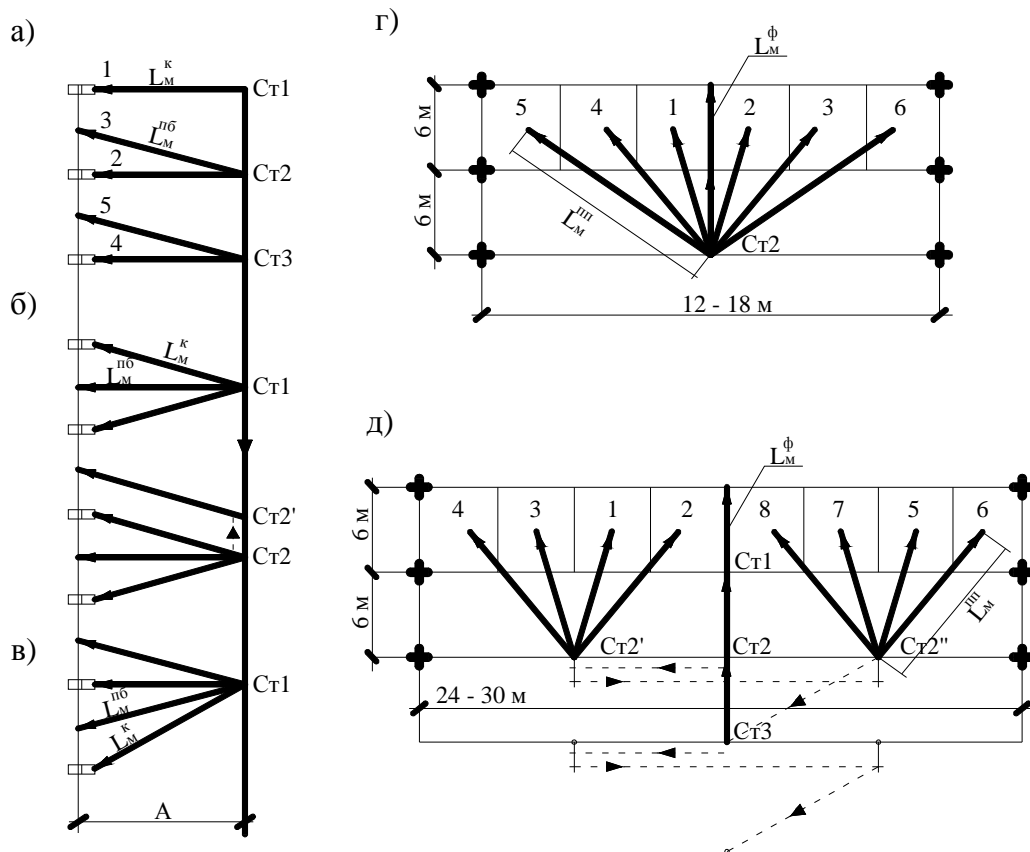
Схеми проходження крана і послідовність монтажу конструкцій під час монтажу одноповерхового промислового будинку:
